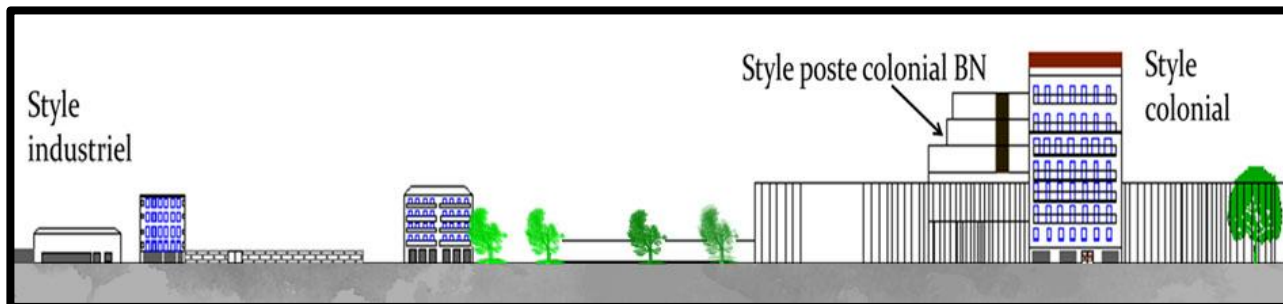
Façade Sud de la rue Mohamed Belouzdad.
